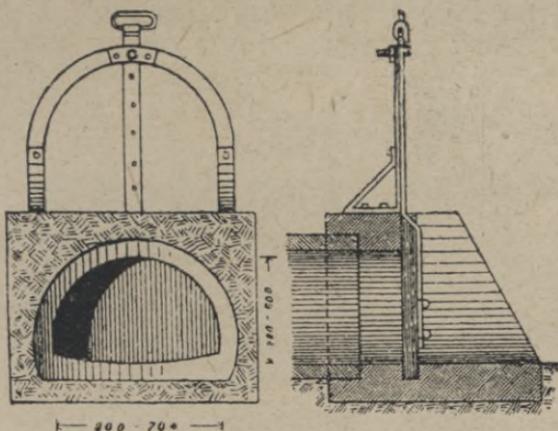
Schleusengerüst mit festem Eisengerüst und Eichenholzschieber für gedrückte Rohre.
